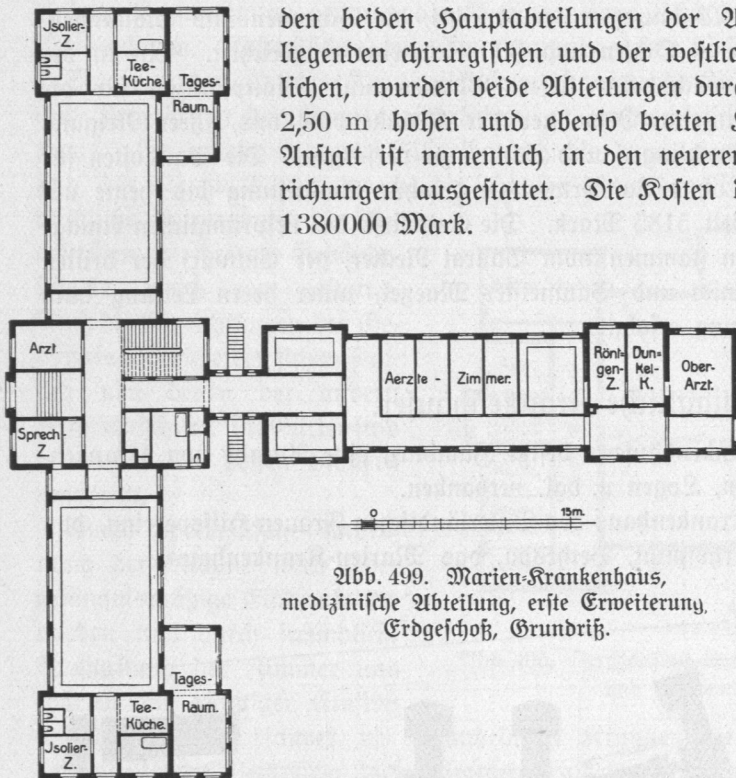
Marien-Krankenhaus, medizinische Abteilung, erste Erweiterung, Erdgeschoß, Grundriß.
